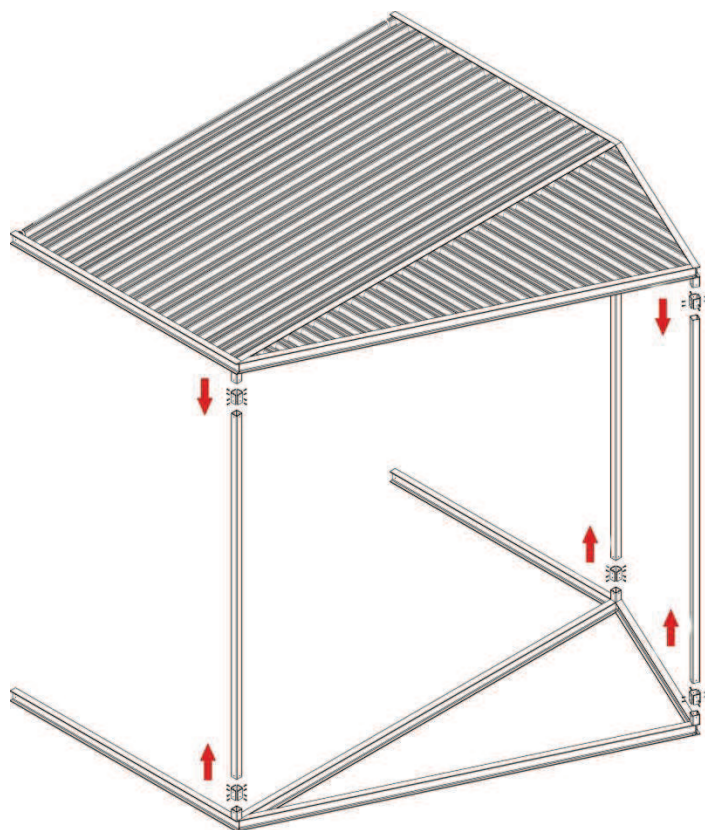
schema di assemblaggio degli elementi strutturali dei volumi additivi, autore tesi
